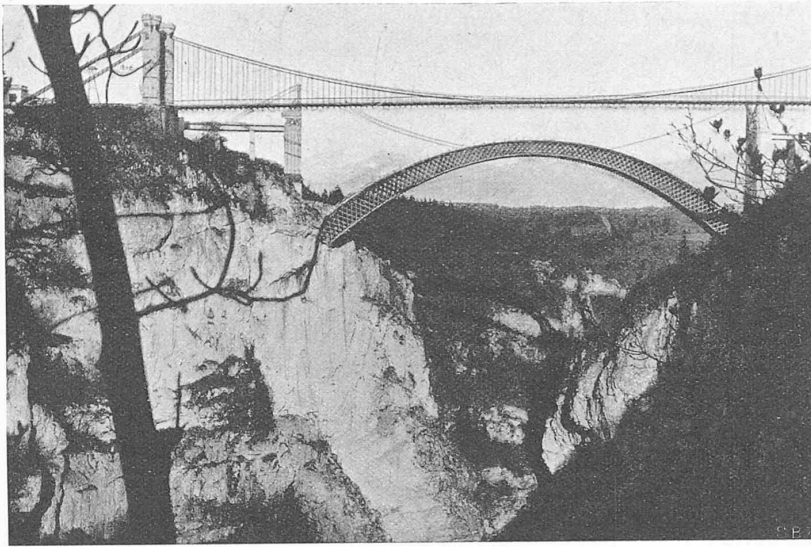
Le Pont de la Caille au-dessus du torrent des Usses. Au premier plan le pont suspendu actuel, au second plan le centre du nouveau pont.
